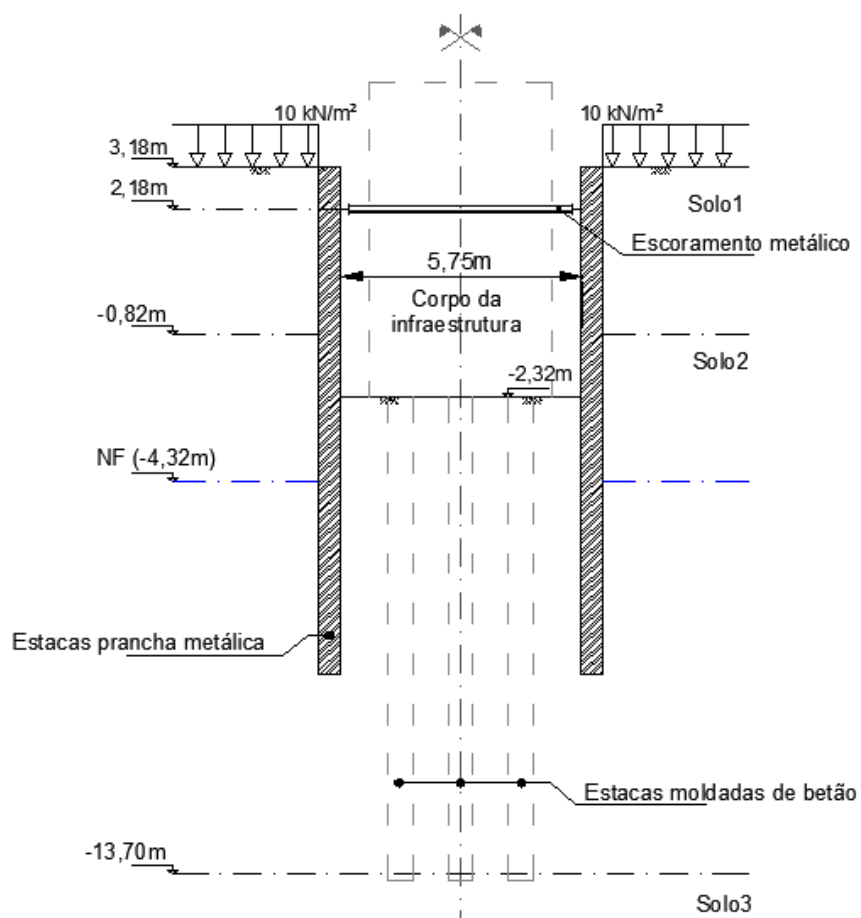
Cortina monoapoiada: Escavação – secção transversal
